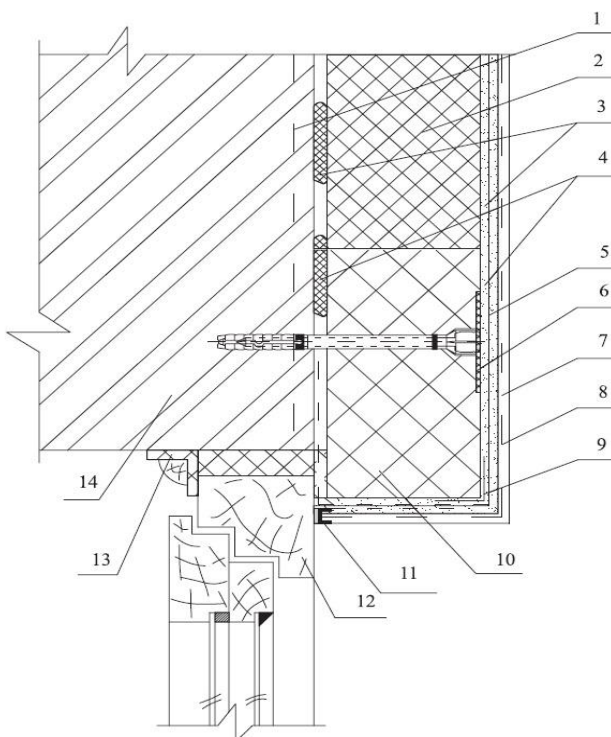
Улаштування теплоізоляції при монтажі вікна врівень із зовнішньою поверхнею несучої стени.
